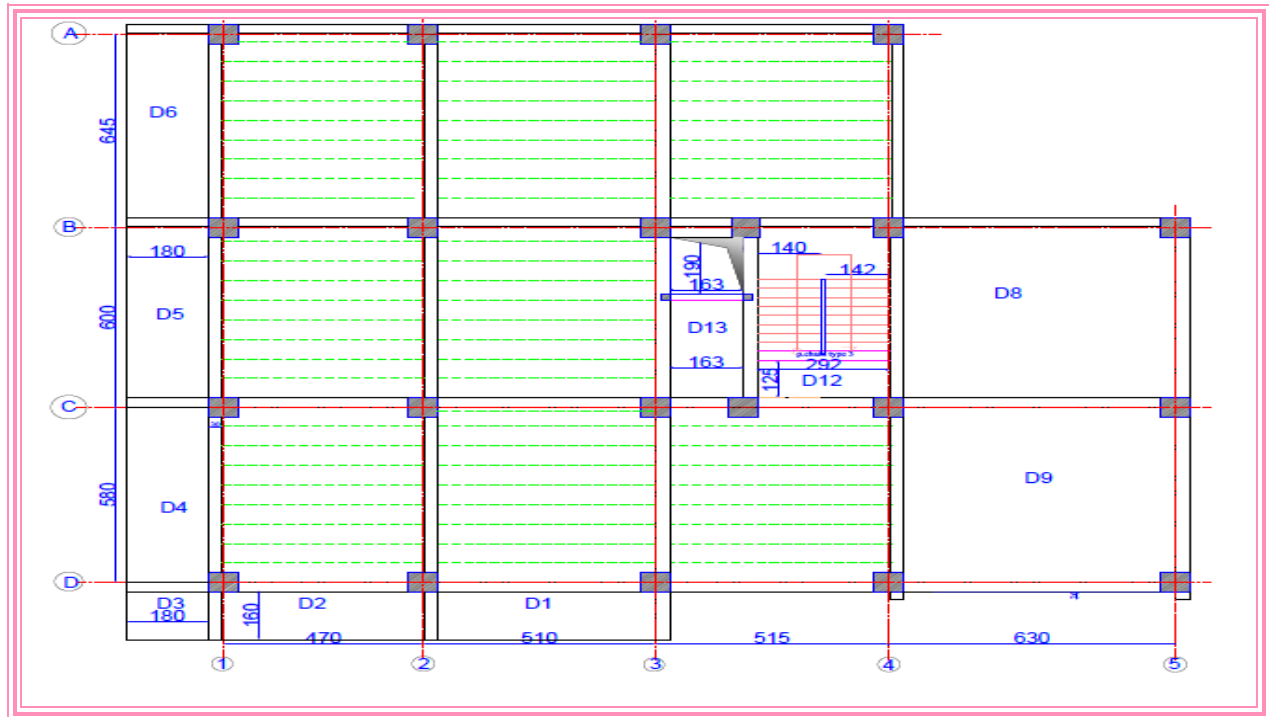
Disposition des poutrelles pour RDC et étage 1 et 2
